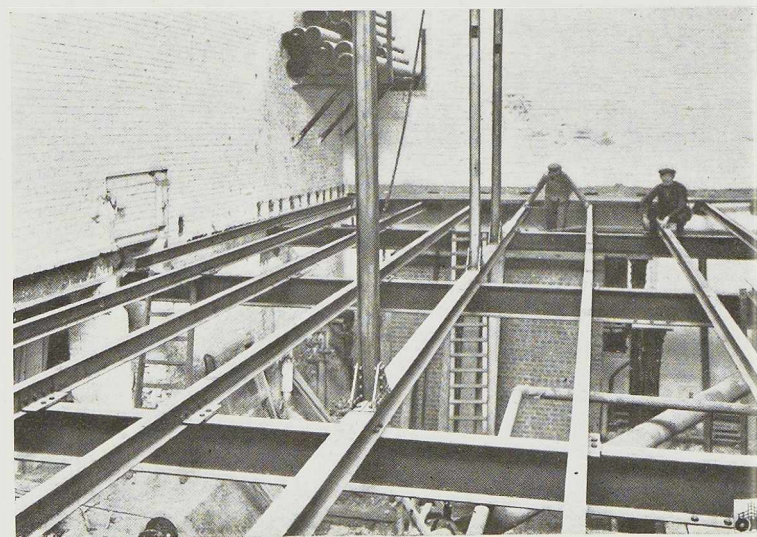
Poutrellage métallique, en cours de construction, de la filature Vanham Frères, à Braine-l'Alleud.
